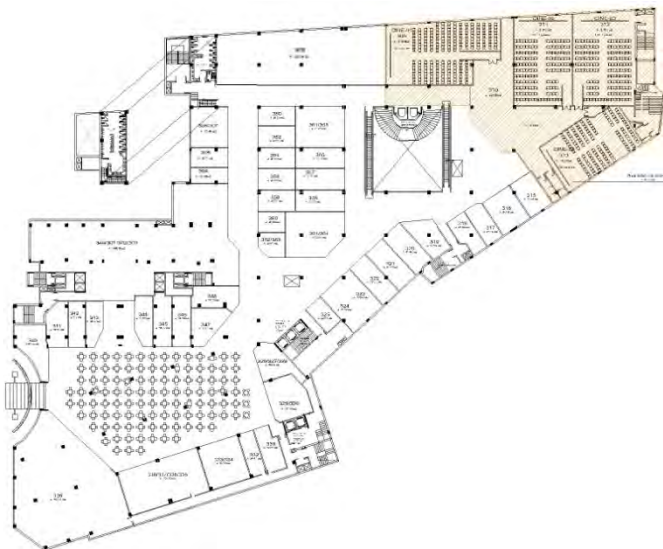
Planta Baixa Terceiro Pavimento Royal Plaza Shopping
